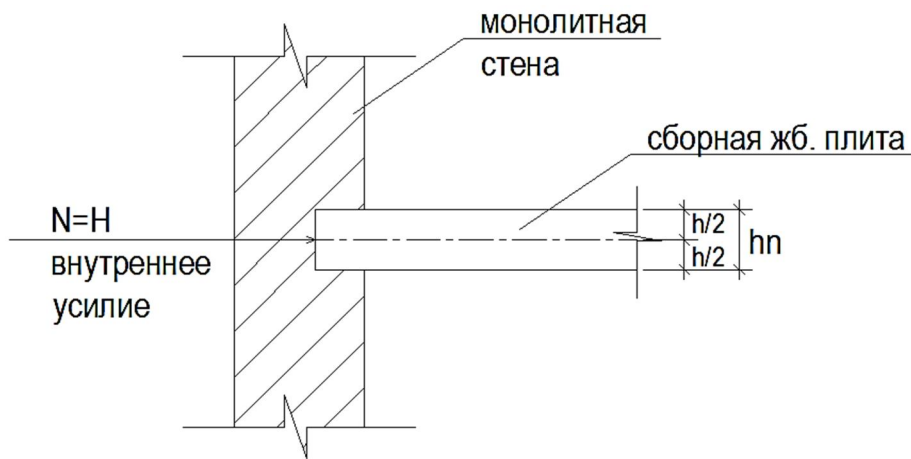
Узел примыкания монолитной стены и плиты перекрытия
